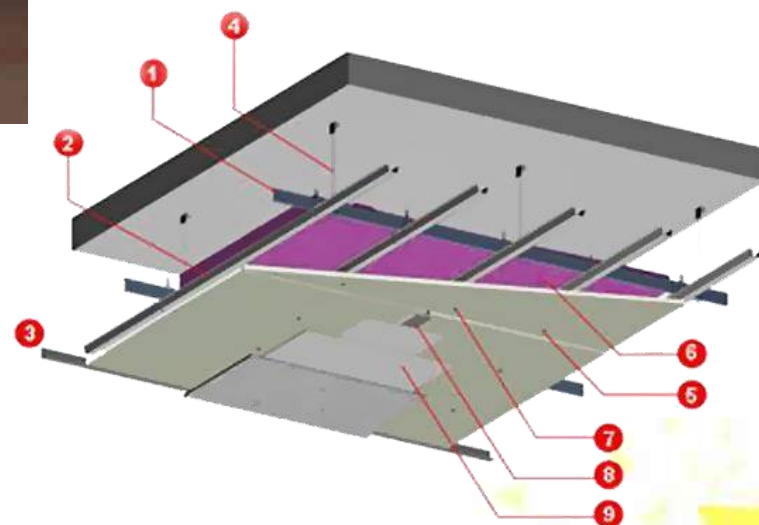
y 152. Salón en b.a y detalle de plafón.
